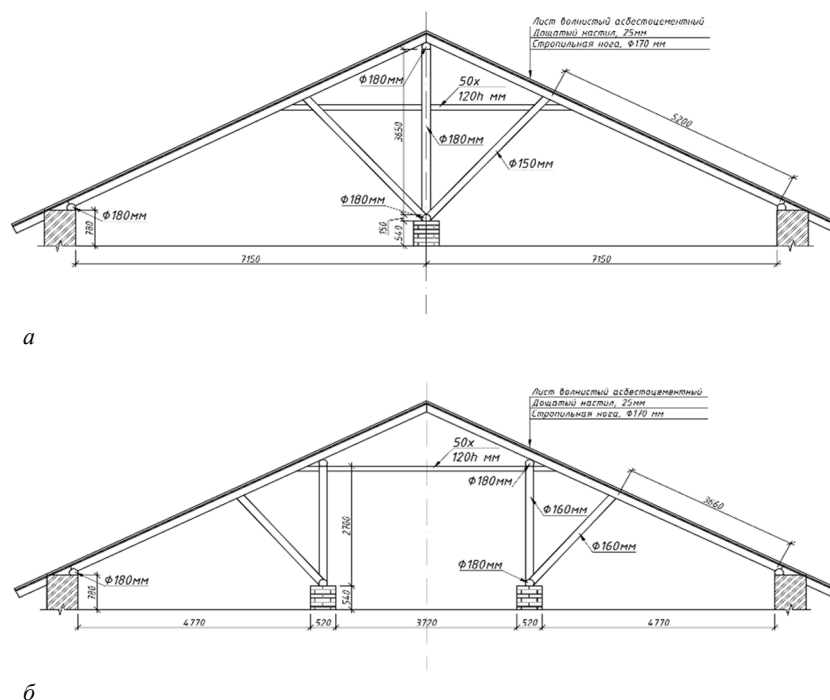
Сечение 1-1(3-3) стропильной конструкции (а).
